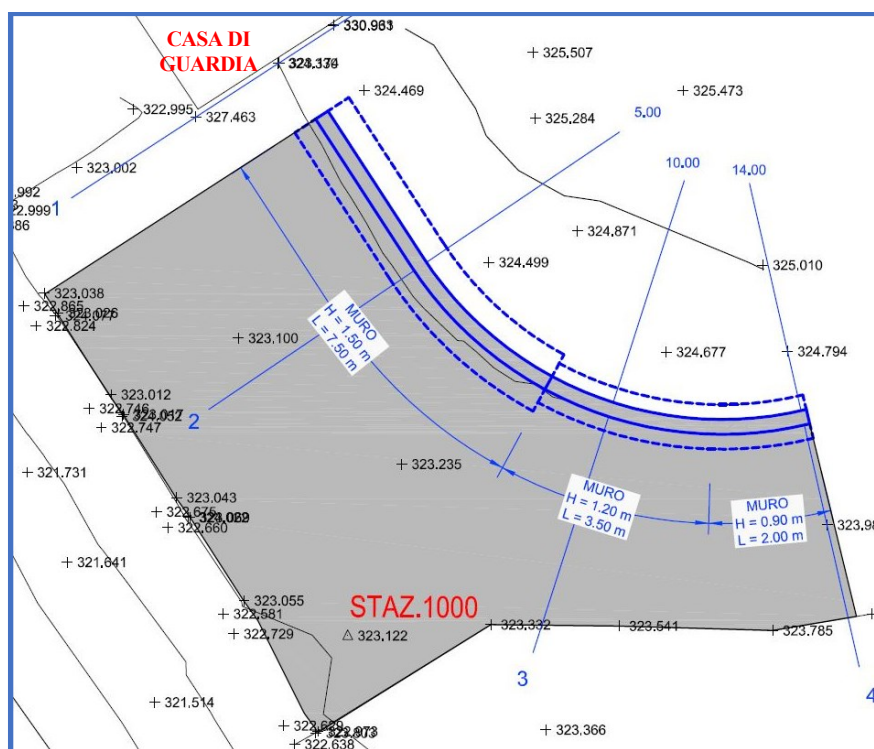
Zona intervento 2 – Sezione tipo dell'intervento
